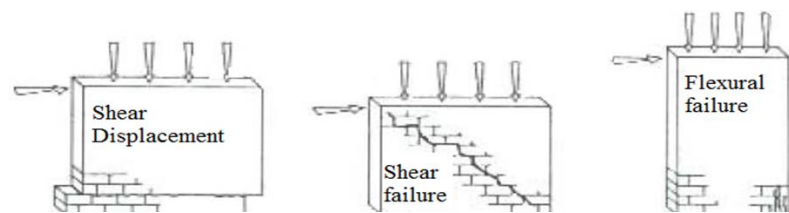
Fallas en Planos de Mampostería (Tomazevic)
